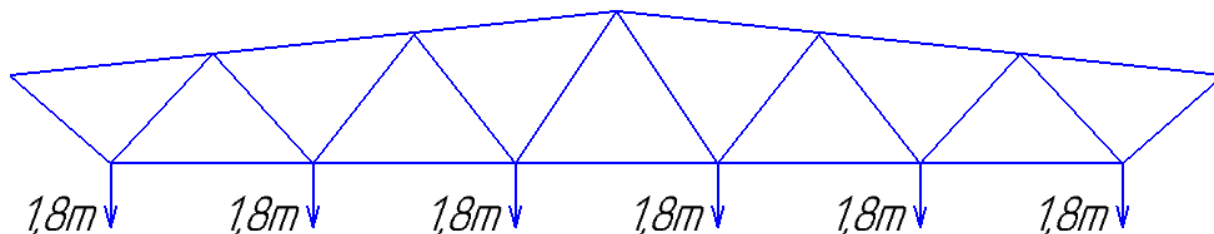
Схема загрузки фермы от веса подвешиваемого оборудования
